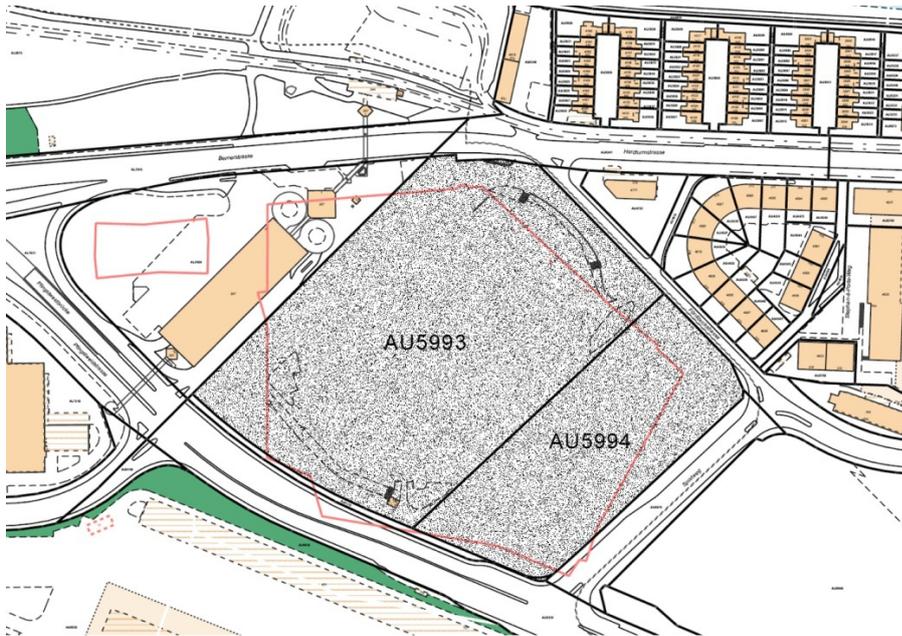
Landkauf durch Stadt (graue Flächen). Parkhausgrundstück westlich und Strassengrundstück östlich (Sportweg) gehören bereits der Stadt.
